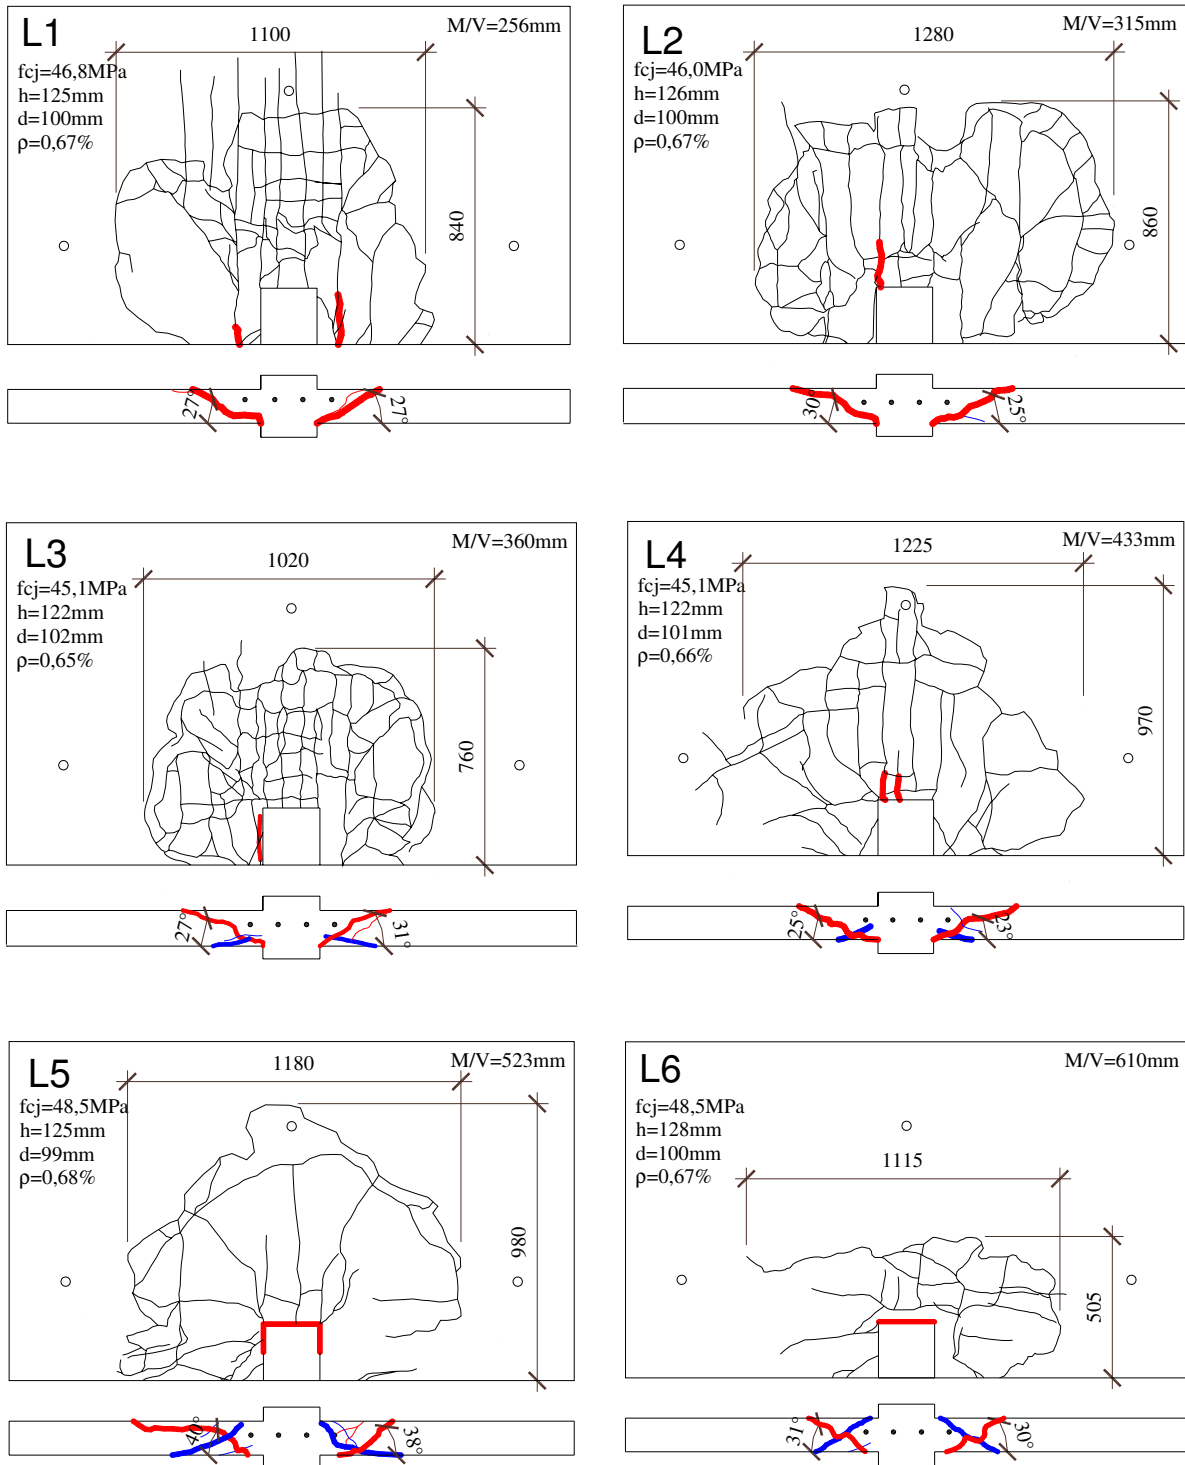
Fissuração e ruptura das lajes L1 a L6
